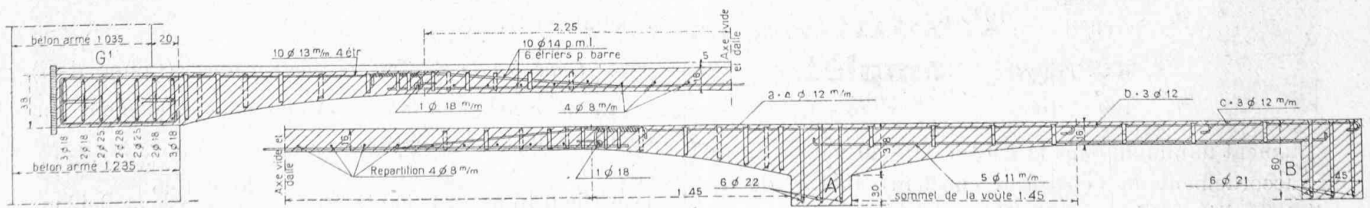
Armatures de la poutraison sur le rez-de-chaussée. — Demi-coupe C-D.
